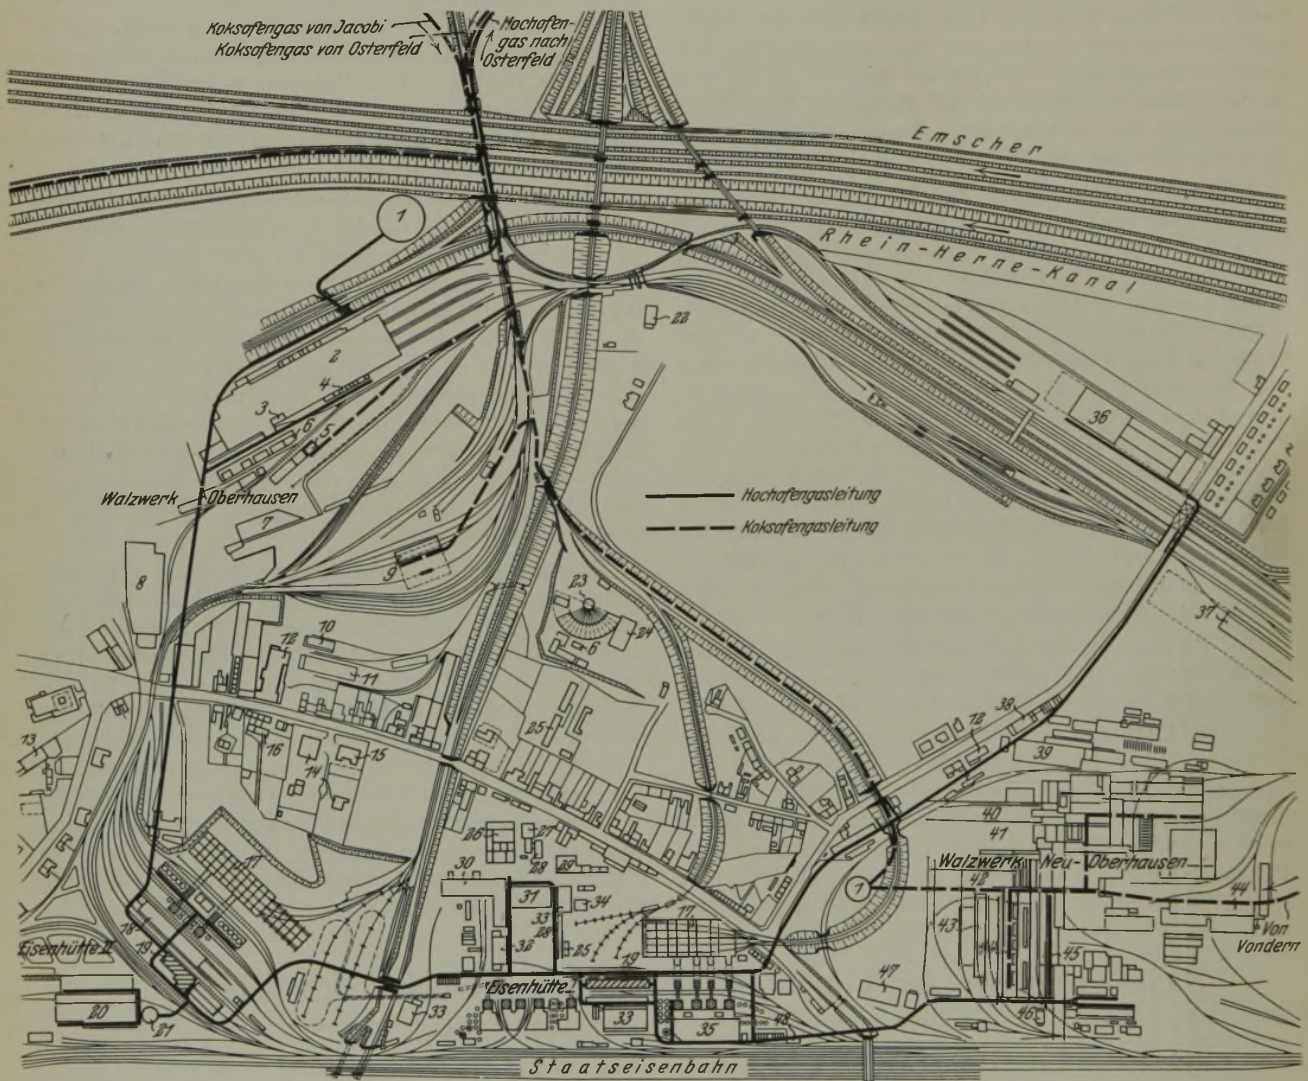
Gesamtanlageplan mit eingezeichneten Gasleitungen.
